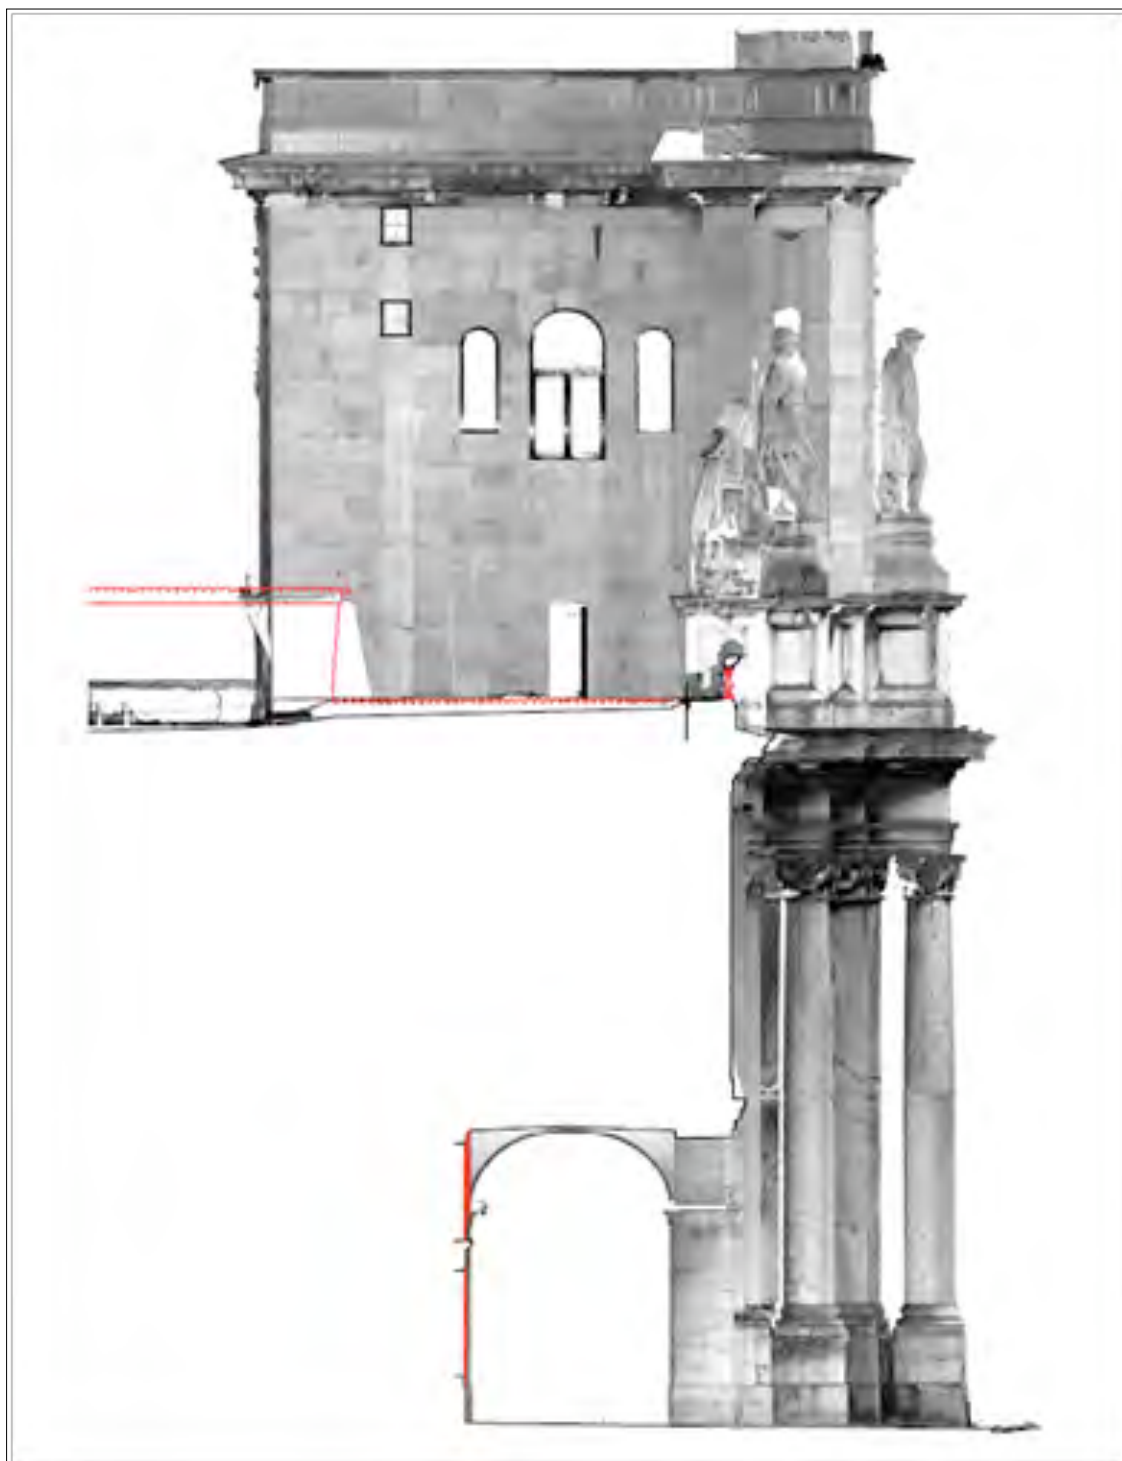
Ortofoto - Prospetto laterale A04.
